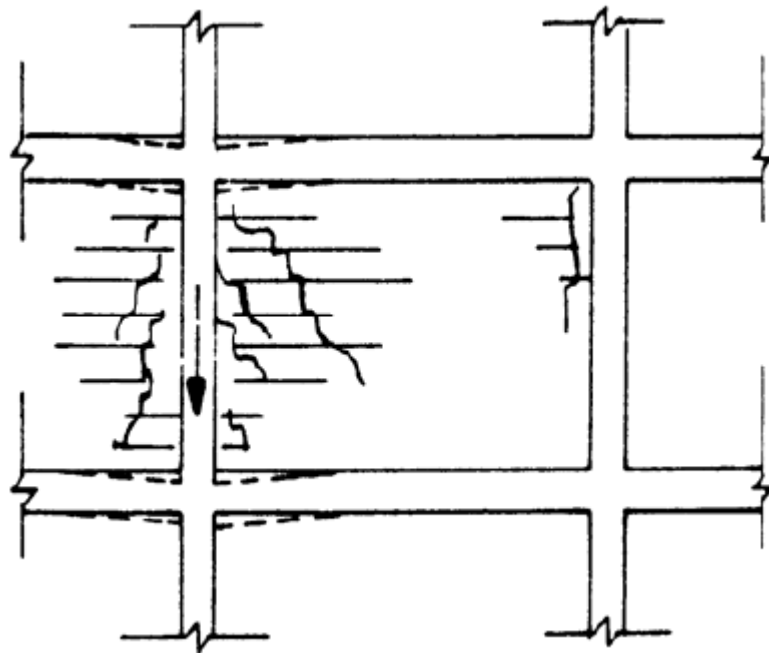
Fissuras devido as tensões induzidas pelo recalque do pilar sob ação de sobrecarga.
